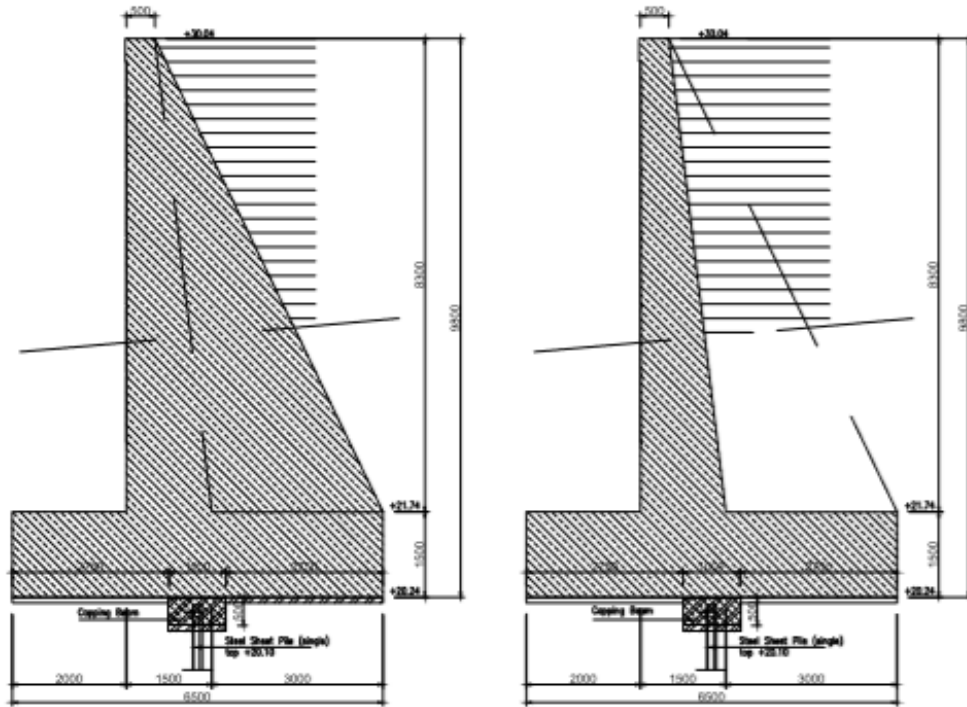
DETAIL PENULANGAN KONSTRUKSI DINDING PENAHAN TANAH TIPE A
